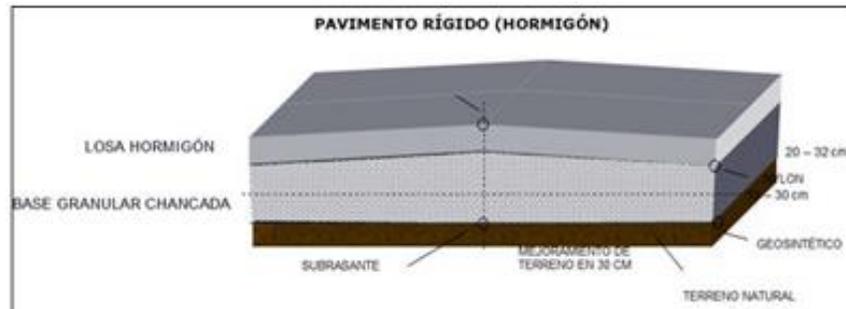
Revestimiento y Pavimento de Hormigón.
